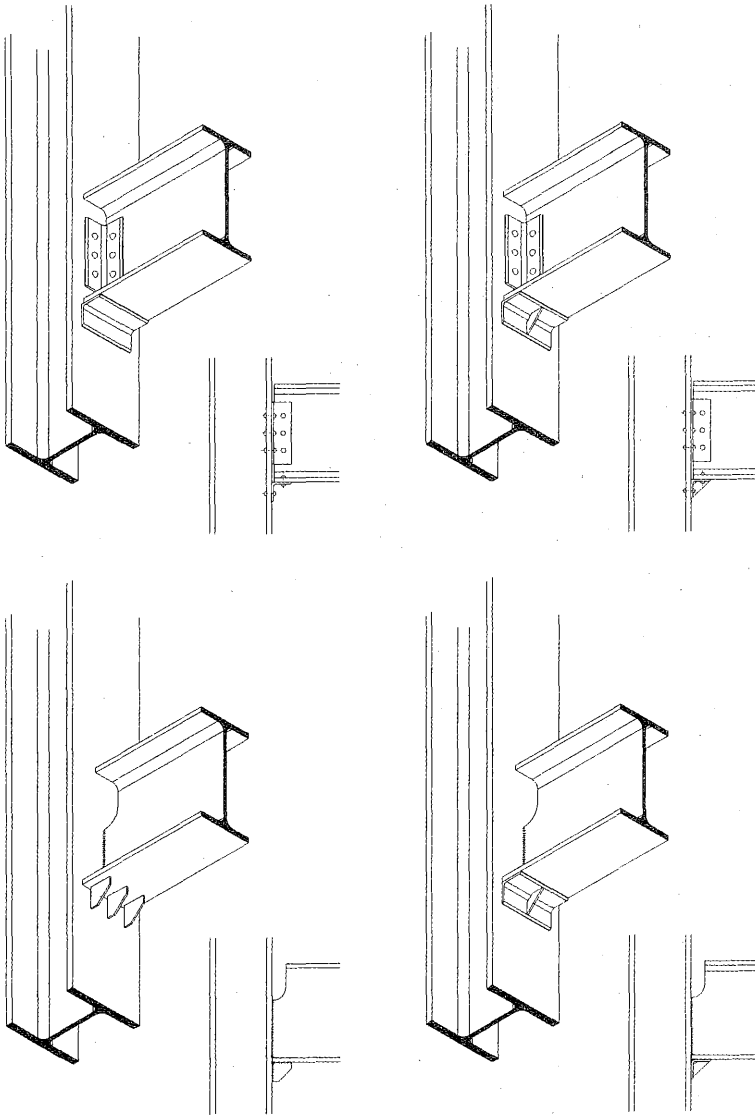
15. Soluciones de apoyo de viga en pilar.
